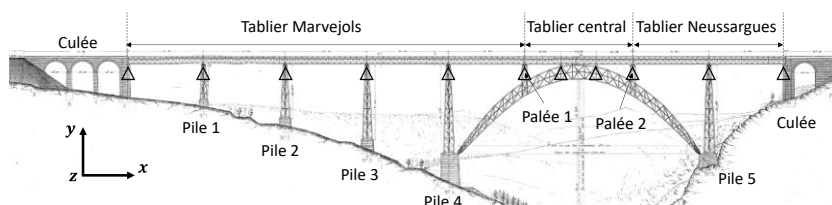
Viaduc de Garabit (Eiffel, 1888a, p. Planche 175)
